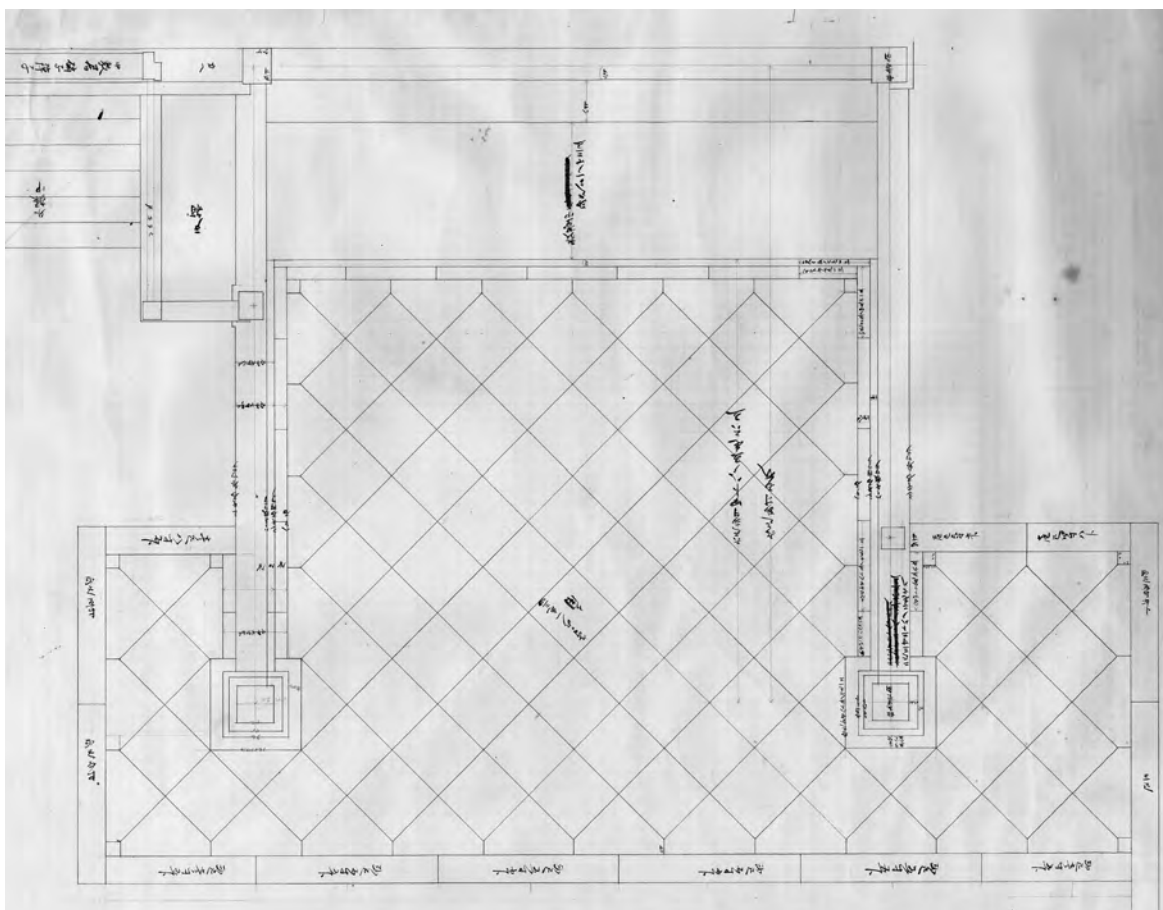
、式台計画図 2、平面図 掛川市蔵 インク書き（墨か？）
